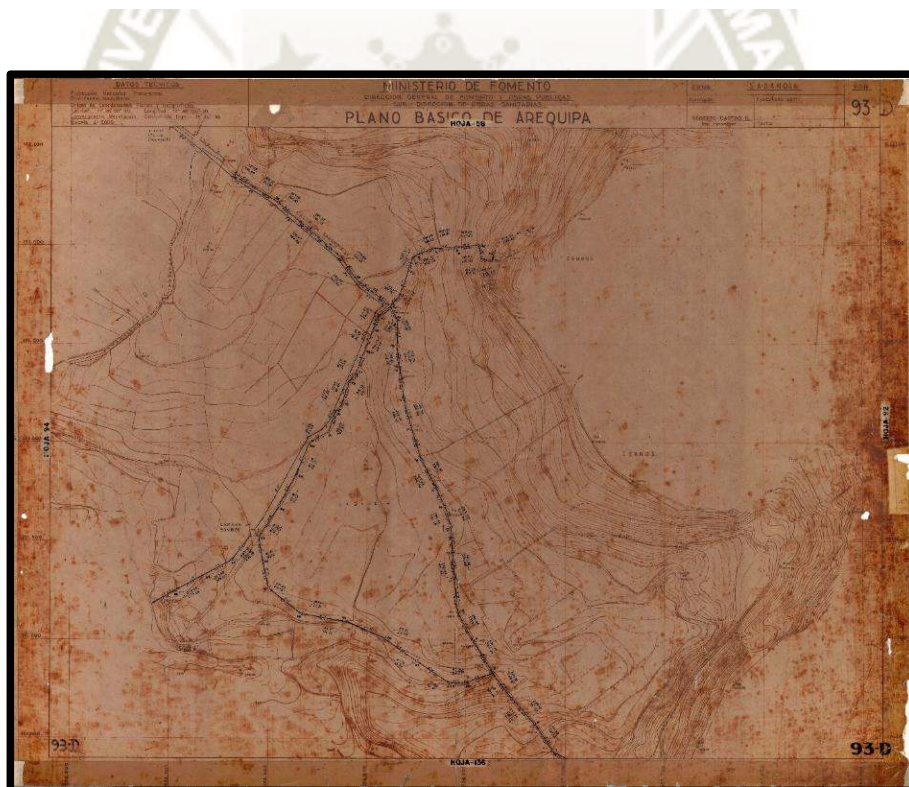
RA-05: Línea de Aducción La Pampa – Planta y Perfil.
